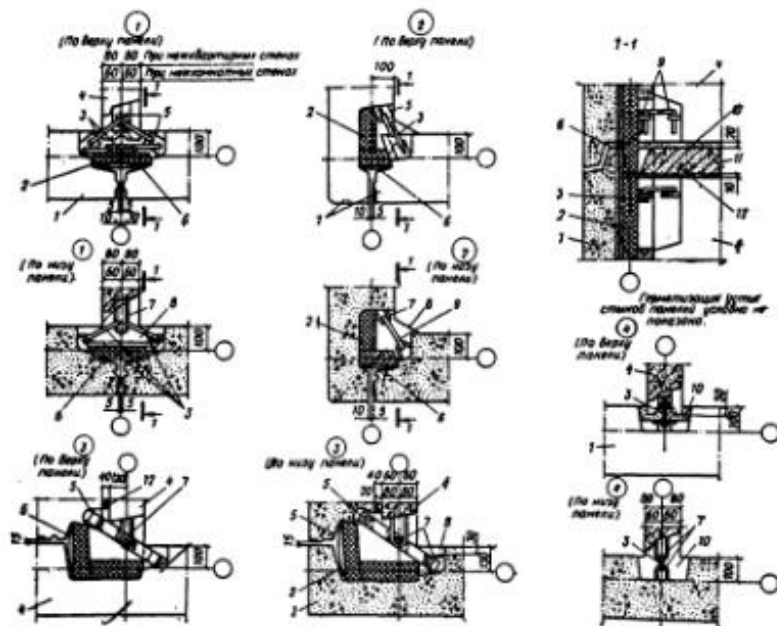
Узлы 1 - 4 сопряжений панелей наружных стен: 1 - панель наружной стены; 2 - утеплитель; 3 - соединительные полускобы; 4 - панель внутренней стены; 5 - стальная пластина; 6 -воздухозащитная прокладка; 7 - арматурные выпуски; 8 - бетон замоноличивания; 9 -соединительные скобы; 10 - цементный раствор; 11 - панель перекрытия; 12 - рейка деревянная
